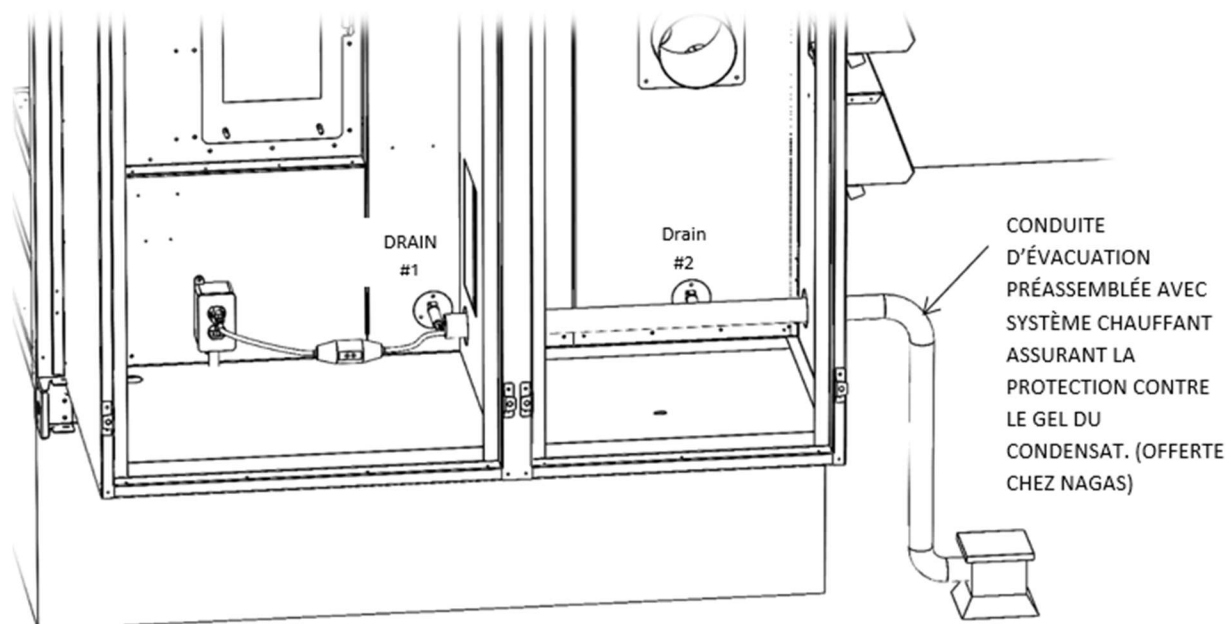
CONDUITE D'ÉVACUATION CHAUFFANTE TYPIQUE POUR UNE INSTALLATION À L'EXTÉRIEUR
